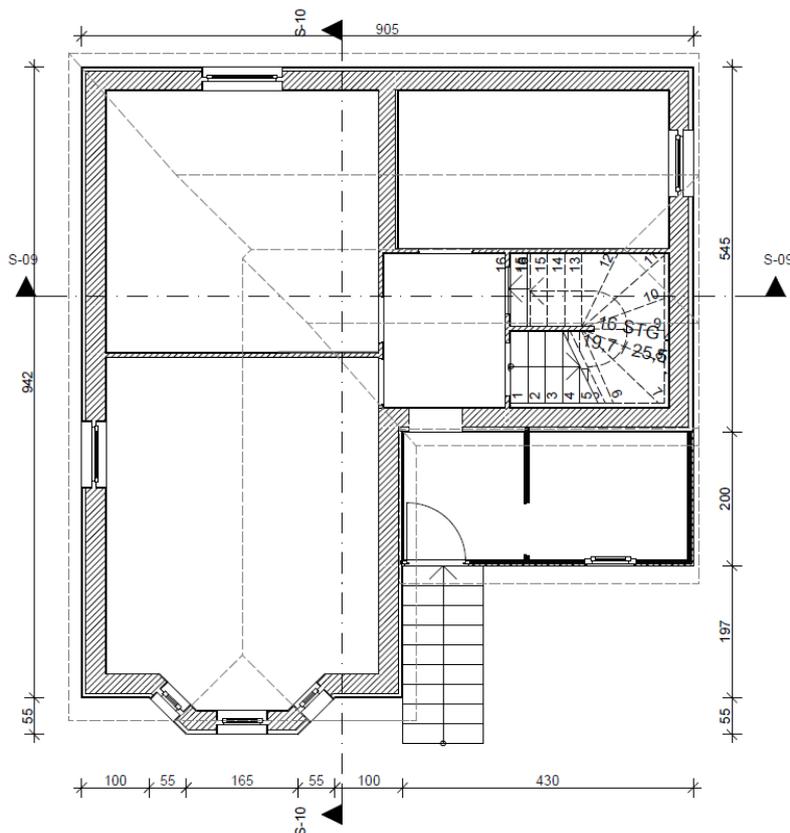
Fallbeispiel - Grundriss Erdgeschoss, Software Archicad 26, (eigene Darstellung)
